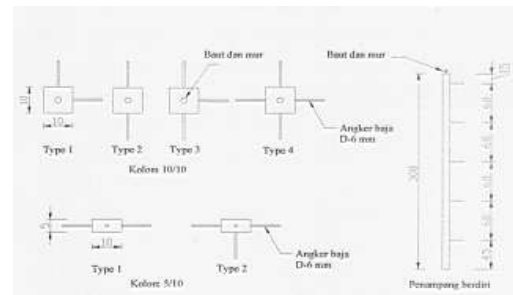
Dimensi Rencana Kolom Beton Pracetak
